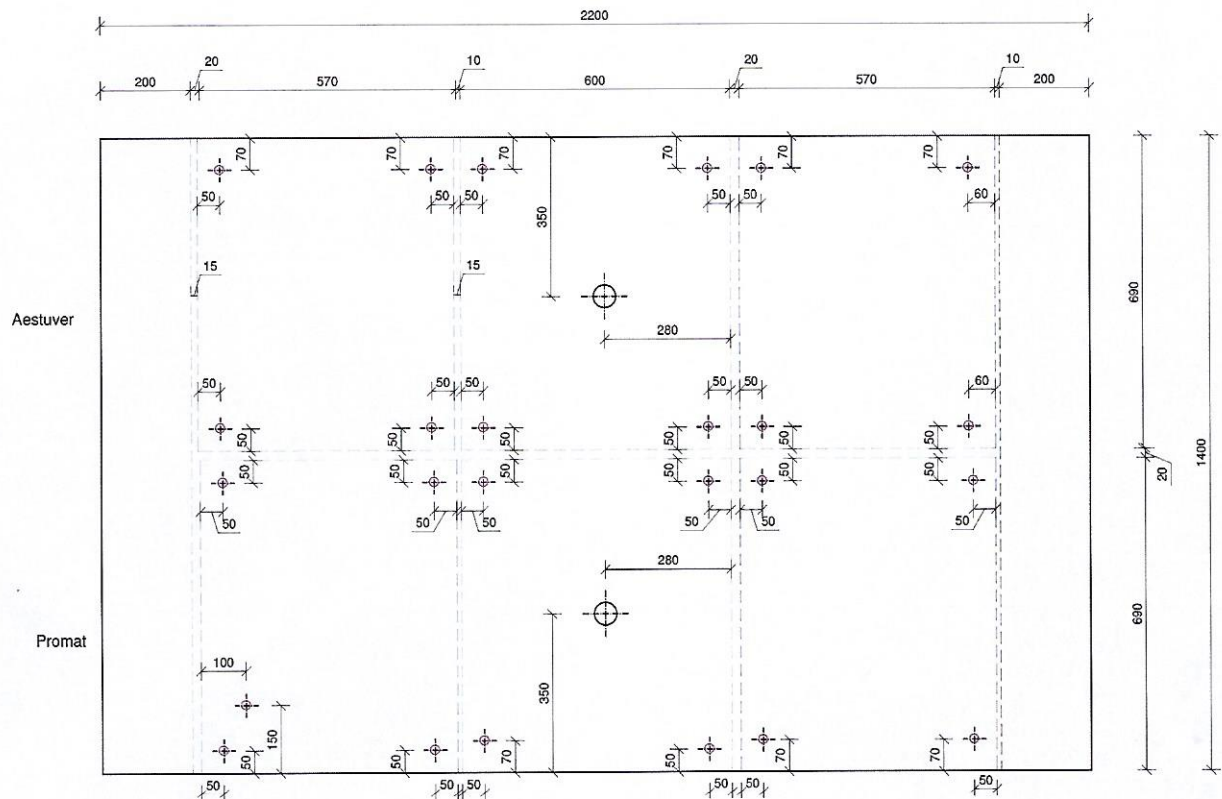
Detailzeichnungen der Anbringung der Brandschutzplatten; Draufsicht von oben
